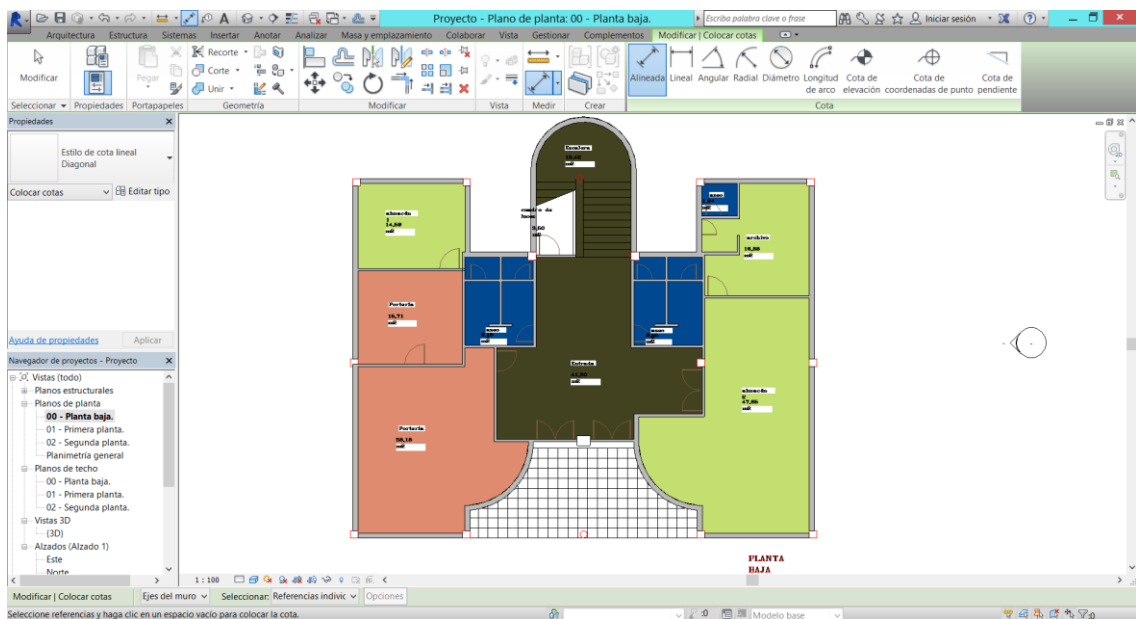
Plano de planta de la planta baja del edificio. Fuente: Elaboración propia.
